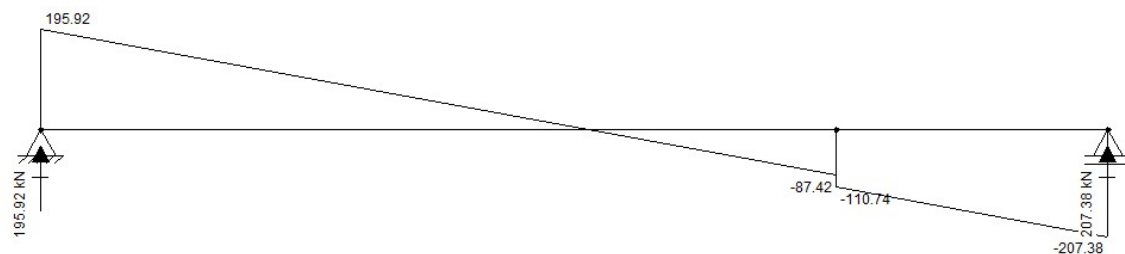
Reações de apoio da viga V7 do teto do 2º pavimento
